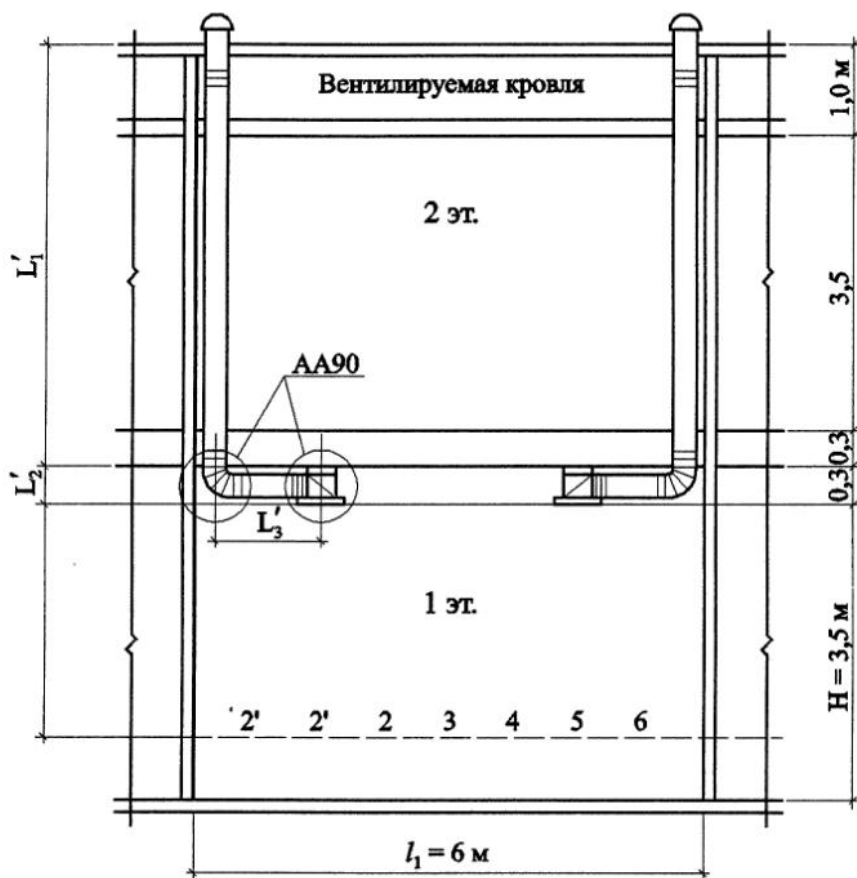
Расчетная схема помещения на 1-м этаже, освещаемого четырьмя световодами (разрез 1-1)
